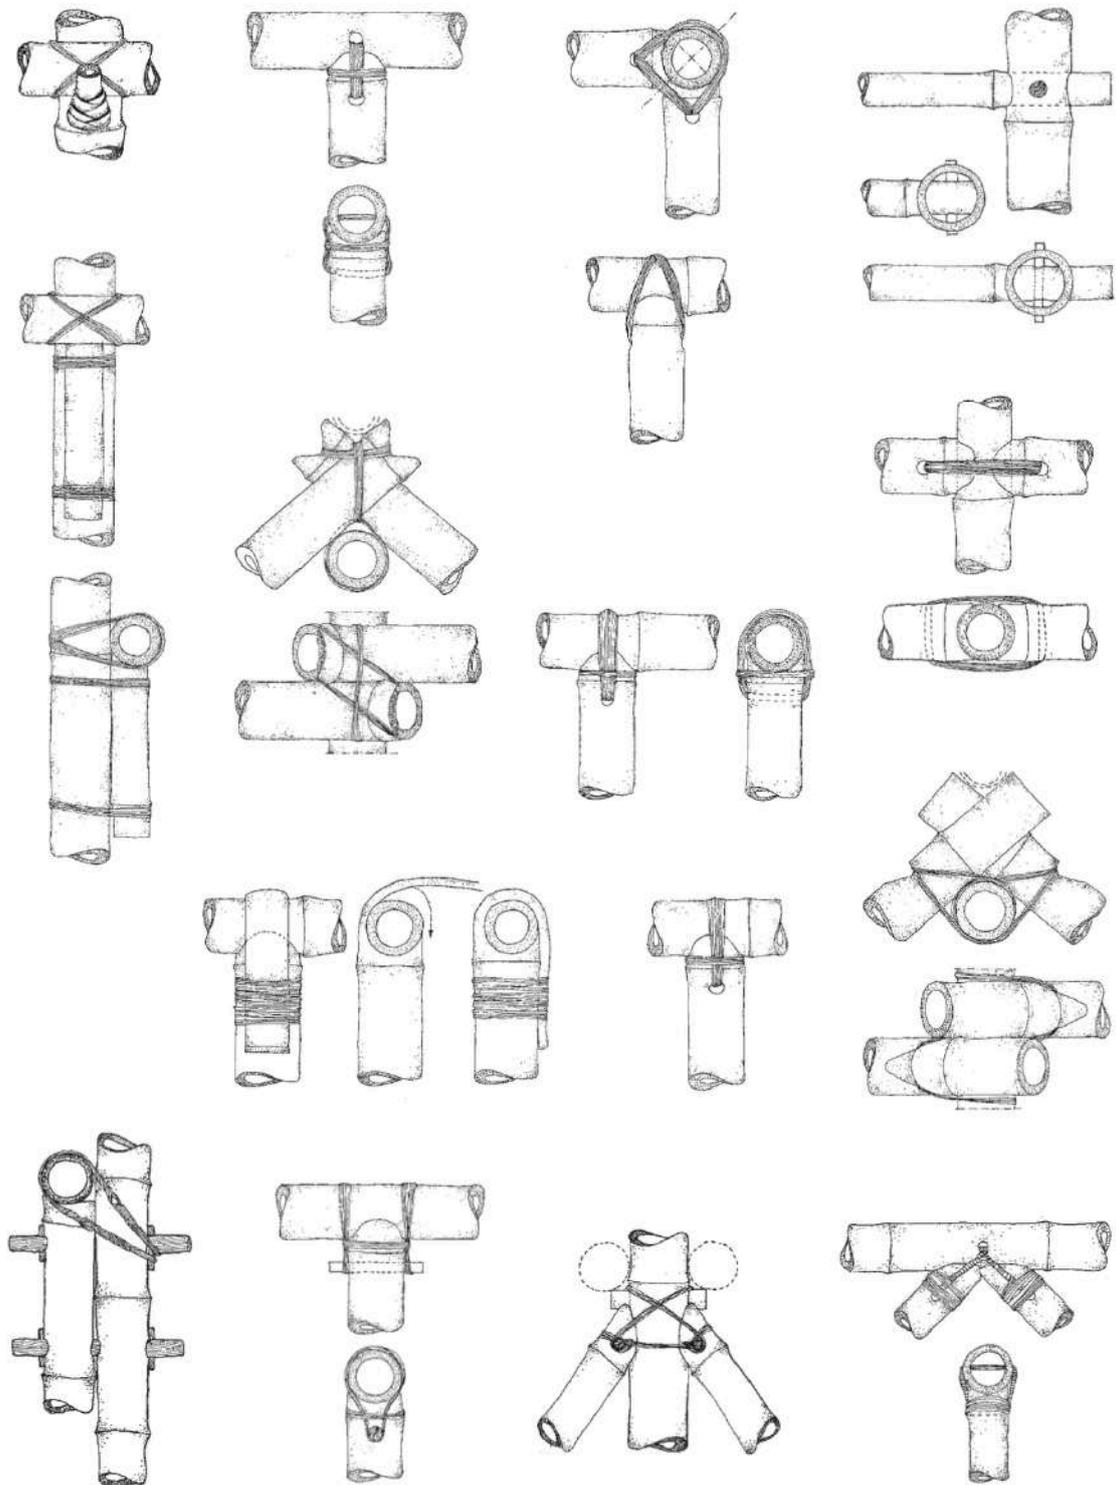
Dessins d'assemblages traditionnels (source : *Building with Bamboo*, Gernot Minke)
